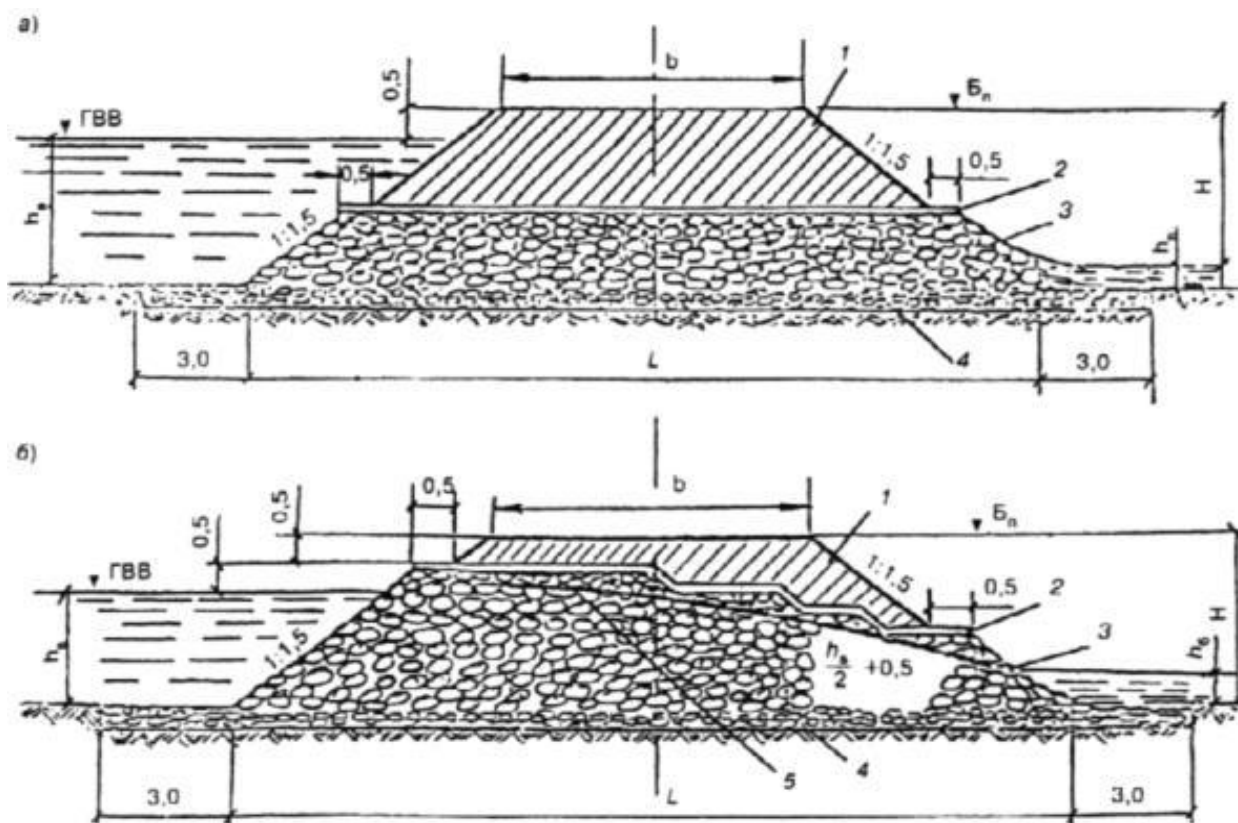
Фильтрующие насыпи. А – напорные, Б – безнапорные. Цифрами обозначено: 1 – земляное полотно, 2 – изоляционный слой, 3 – фильтрующая часть насыпи, 4 – укрепление основания, 5 – кривая депрессии. ГВВ – расчетный горизонт высоких вод перед сооружением (ФПУ).  $H_в$  – допускаемая высота потока перед насыпью,  $h_б$  – бытовая глубина потока,  $L$  – длина фильтрующей насыпи.
